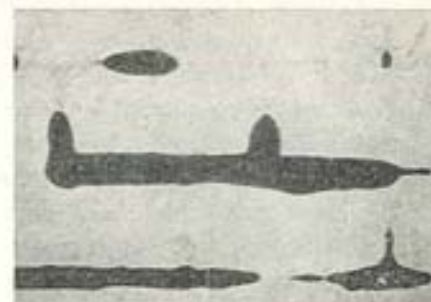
Indvendigt puds med fugtskjolder langs mureværkets fuger.
